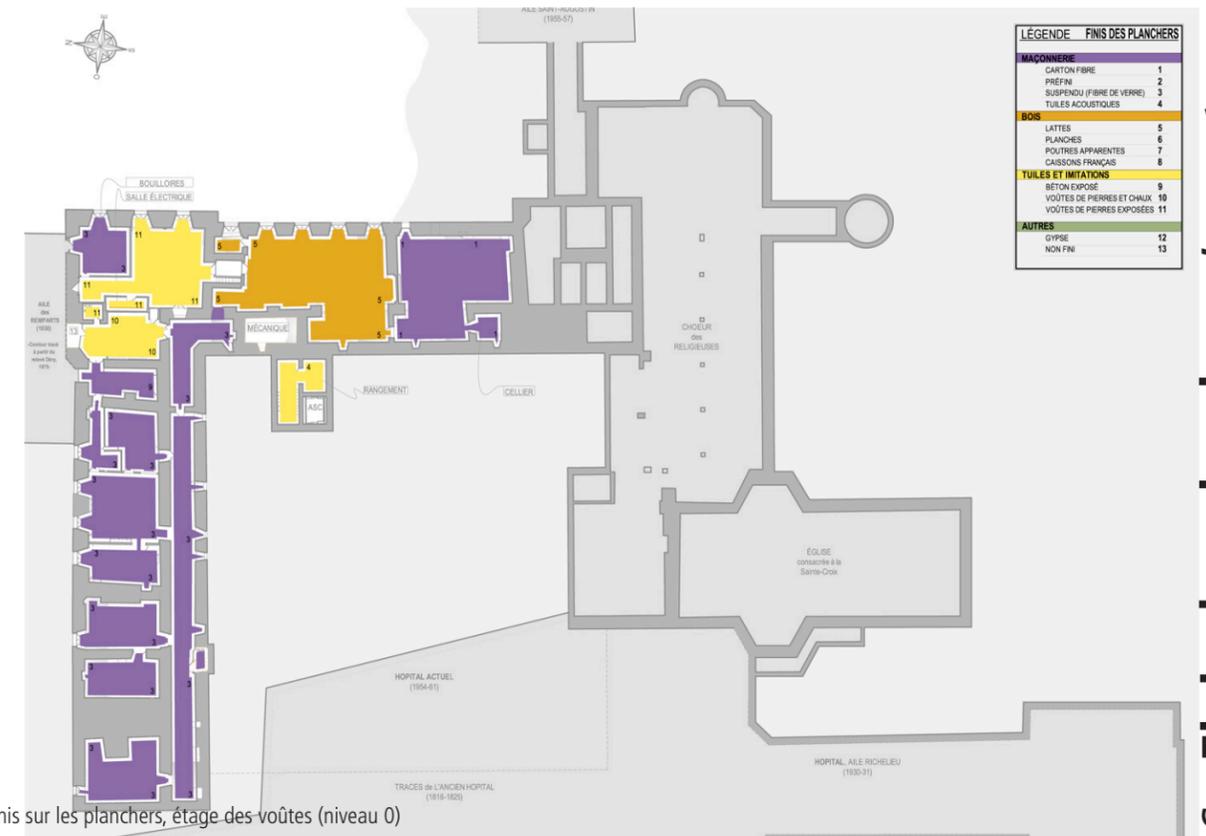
Plan des fins sur les planchers, étage des voûtes (niveau 0)
